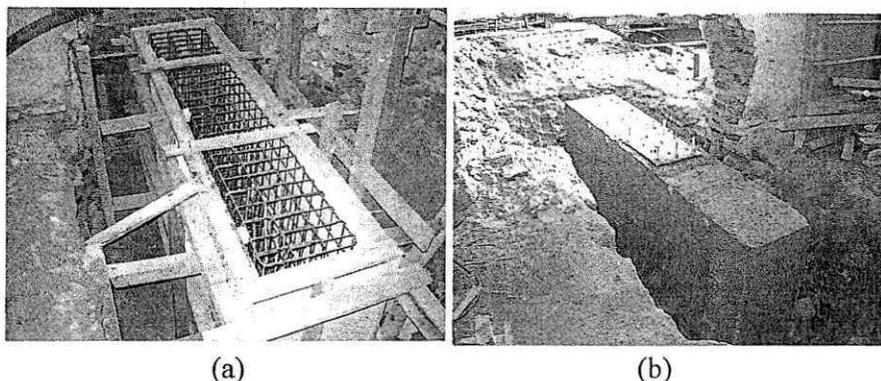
(a) Locação da forma do bloco que servirá de base para o pilar; (b) bloco concretado e com peça metálica, que servirá de encaixe para o pilar, chumbada.
